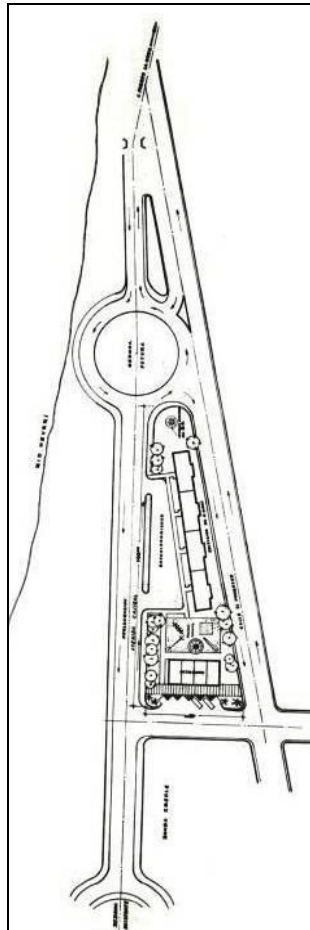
b. UC Barcelona. Plano de Conjunto (1957)
